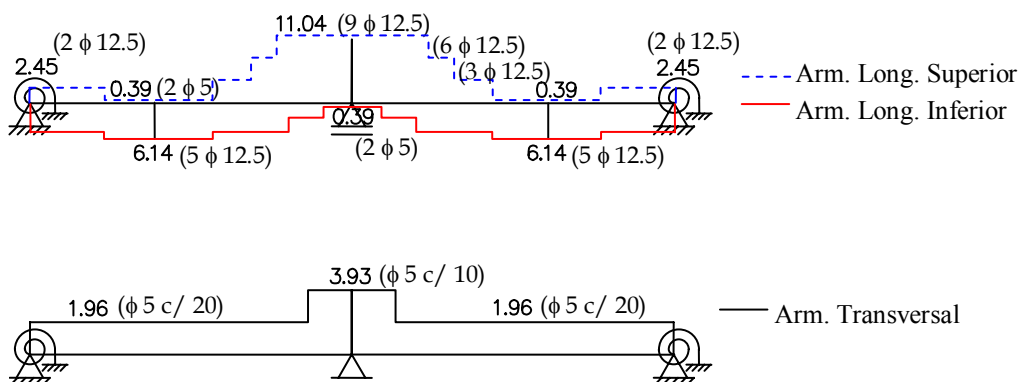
Diagramas de armadura adotada da viga isolada do Exemplo 2 .
